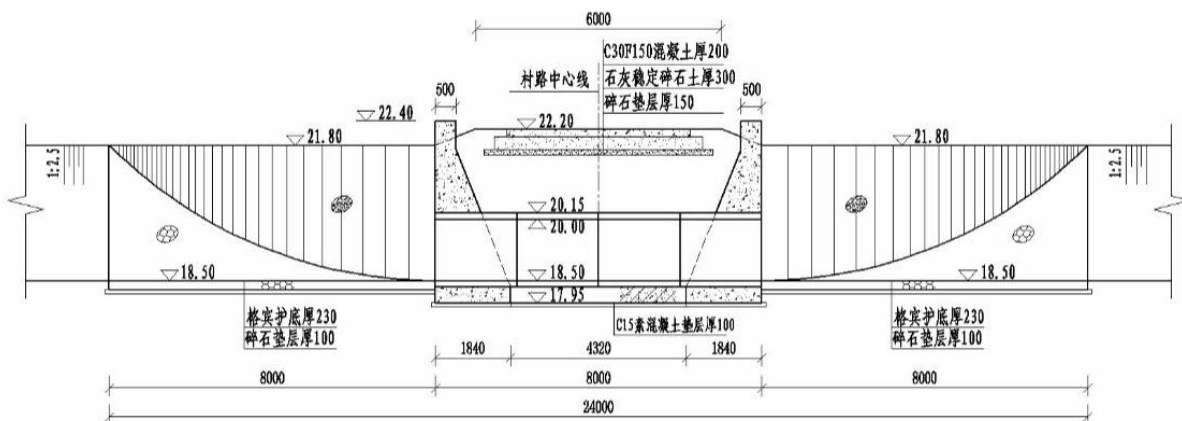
2孔 DN1500 交通涵典型设计纵断面图
